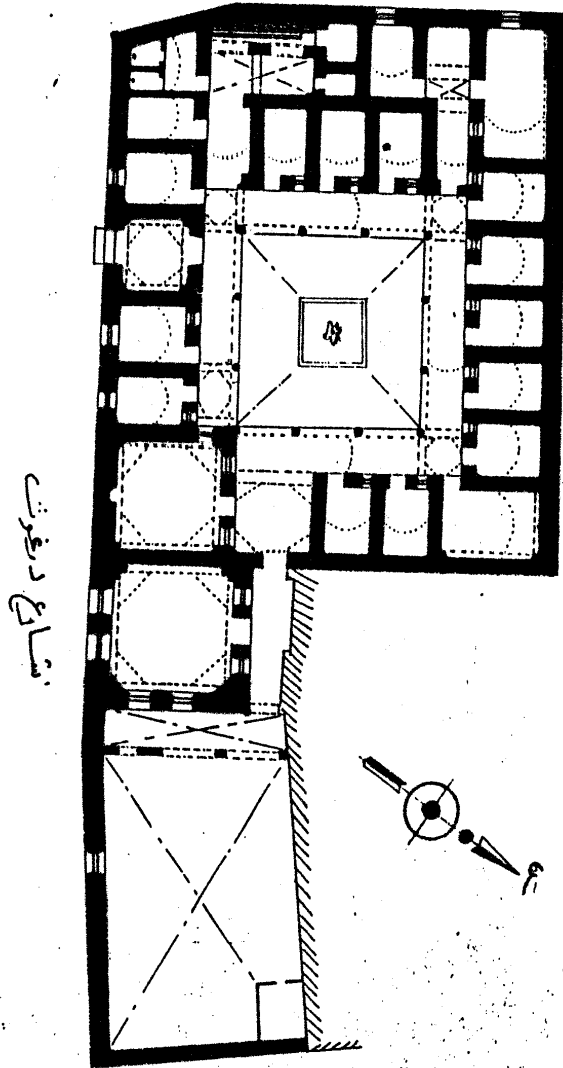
مسقط افقى لمسجد محمود (١٠٩١هـ/١٦٨٠م)
